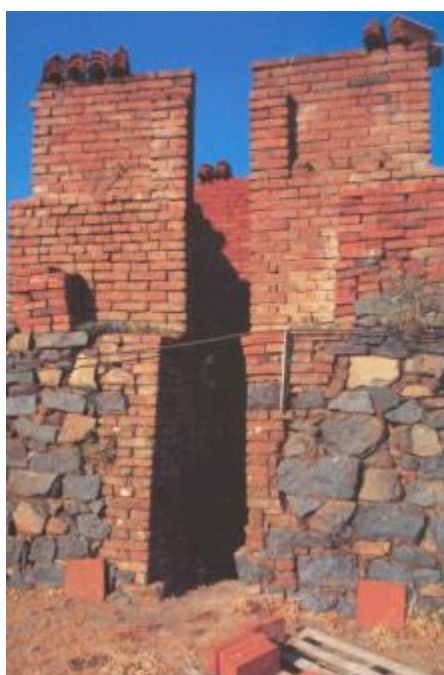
Exemplo de parede de alvenaria de tijolo cozido (Sousa, 2003)
